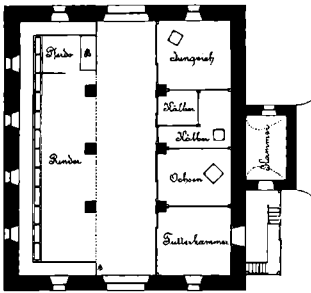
Grundriss des Erdgeschosses des Sank-Stadel's.
